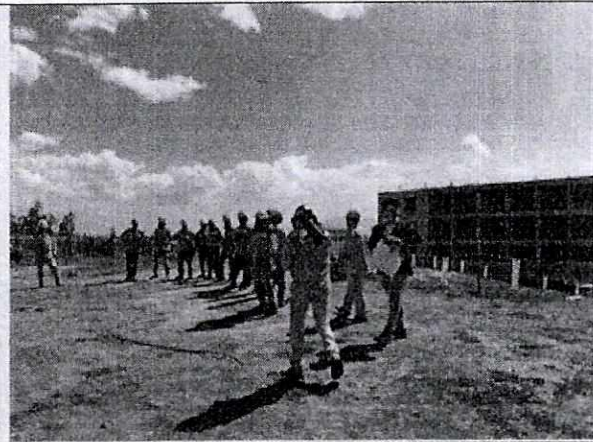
Vista exterior de la construcción – desalojo de trabajadores
